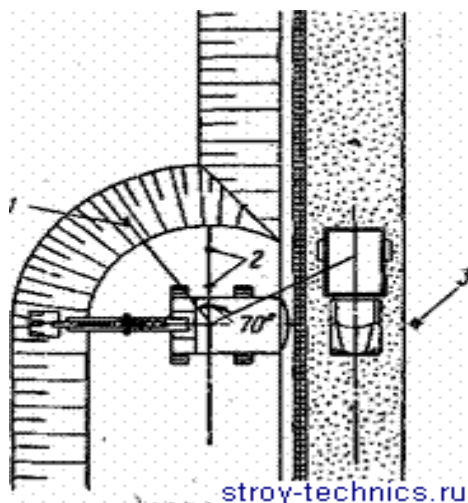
Схема разработки забоя прямой лопатой с погрузкой грунта в автосамосвалы:
